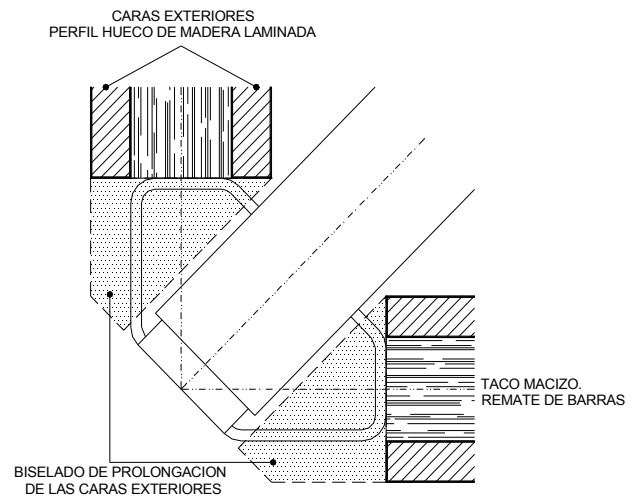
Planta de nudo con ocultación parcial de los elementos metálicos.
